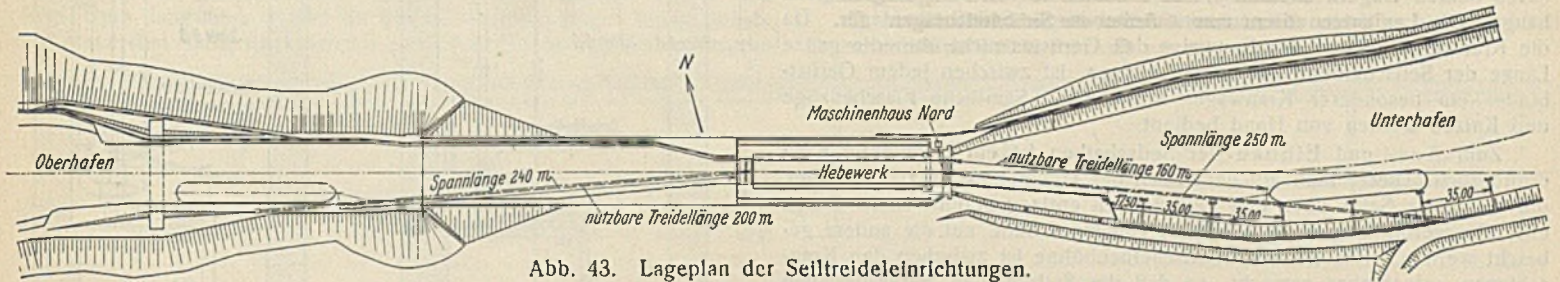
Lageplan der Seiltreideleinrichtungen.
